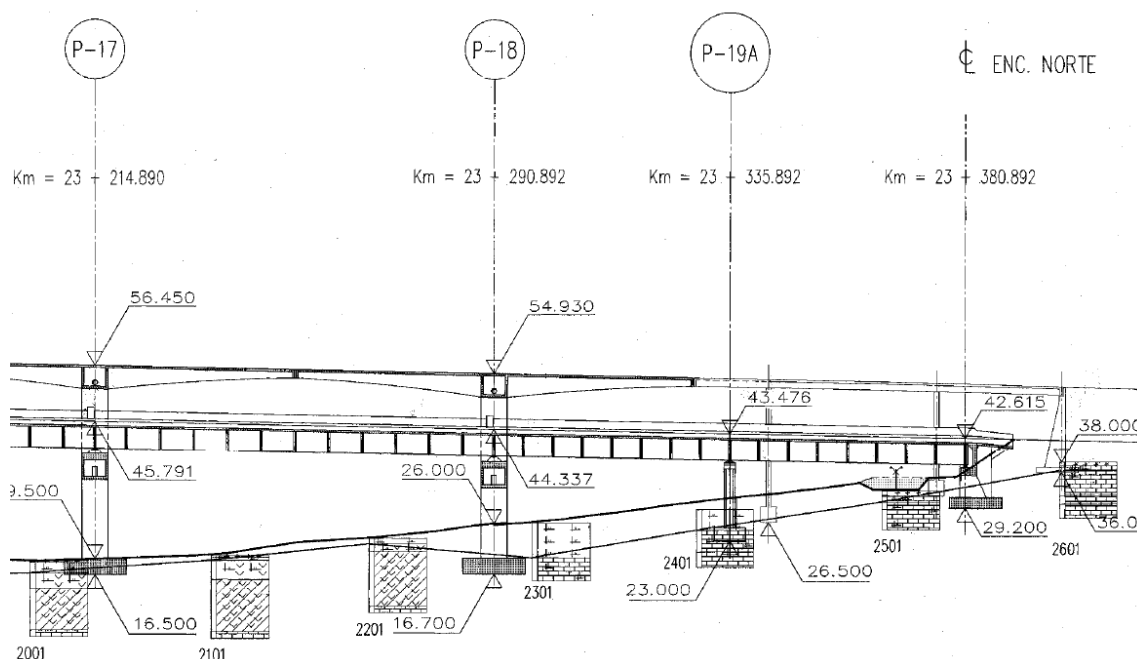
Perfil longitudinal do tabuleiro rodoviário e ferroviário (Peça desenhada nº 76 do Projeto de Execução – 1996)
